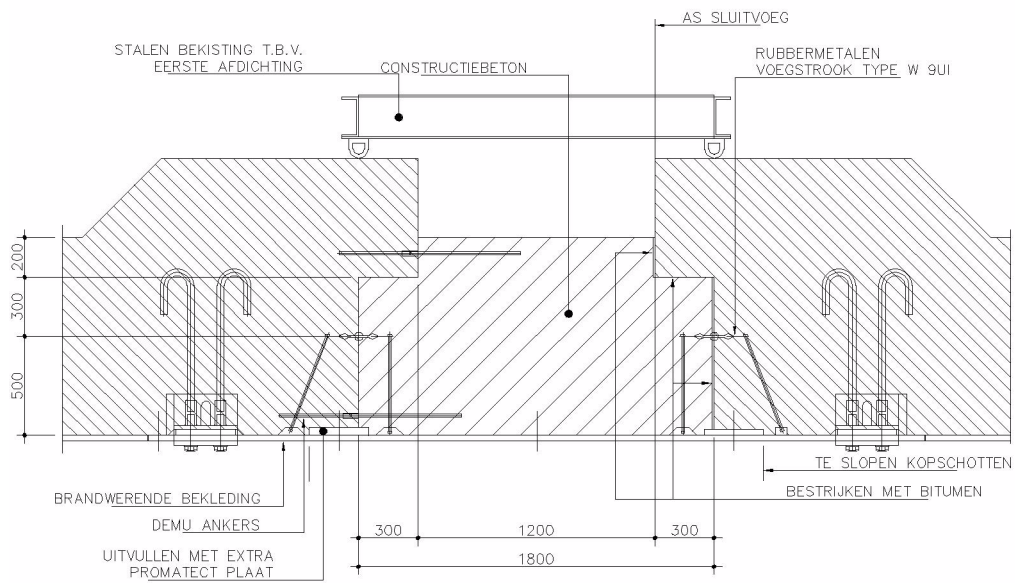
Voegafwerking wand zonder tegels (5.2.9.5)
